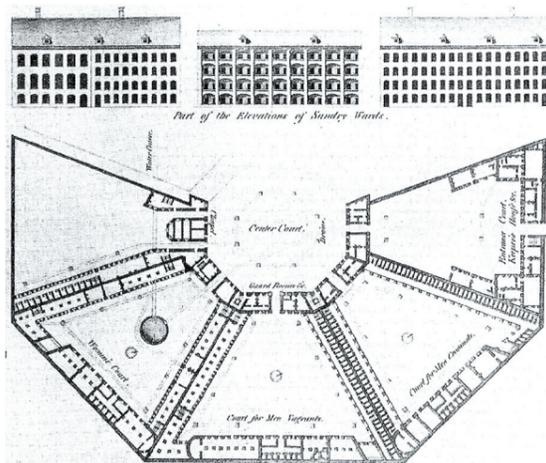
Grundriss | Ansichten Maison de Force
